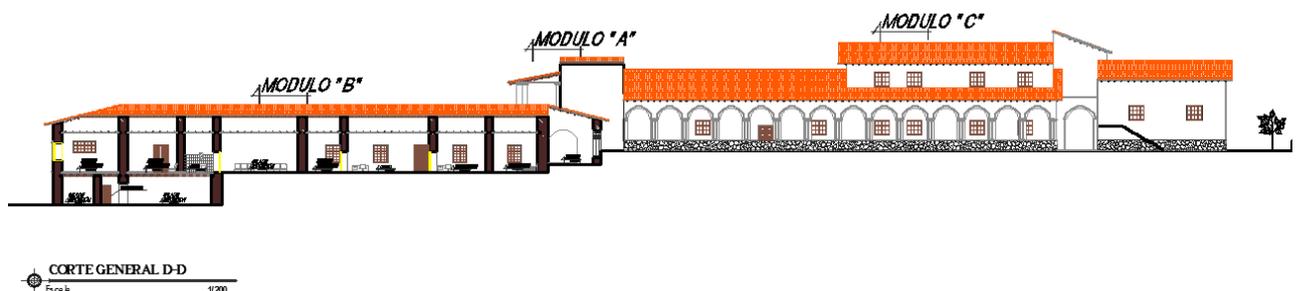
Corte general D-D, del conjunto arquitectónico donde se evidencia claramente una expresión arquitectónica muy de la época colonial
